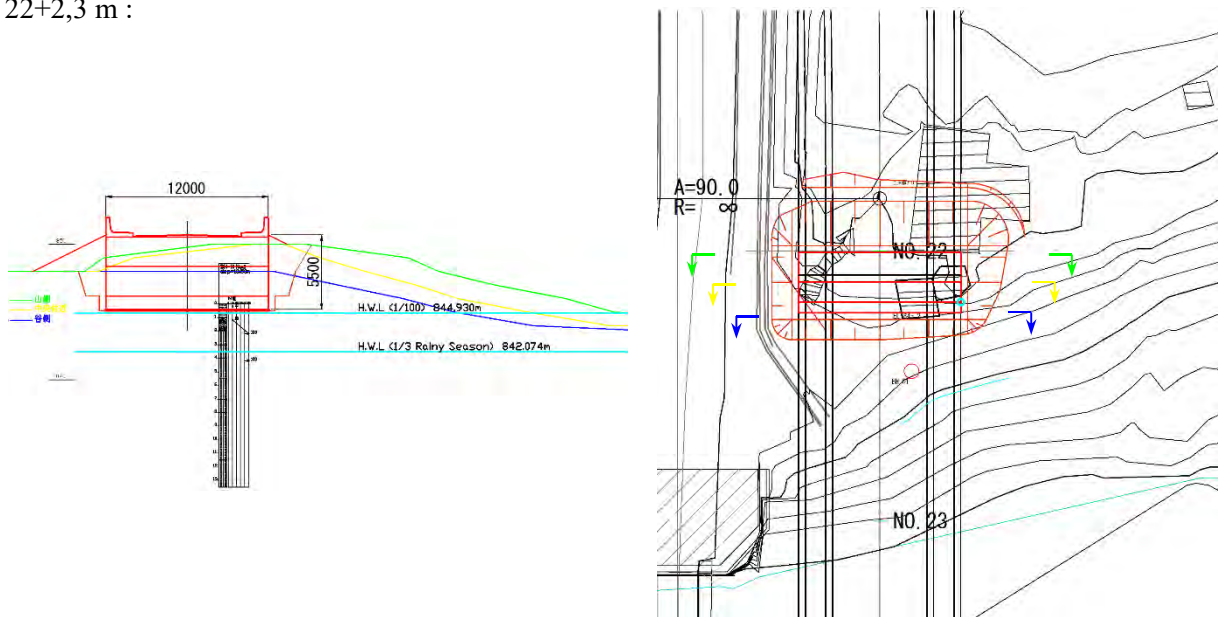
Variantes de l'emplacement de la culée A1 (vue transversale et vue en plan)
